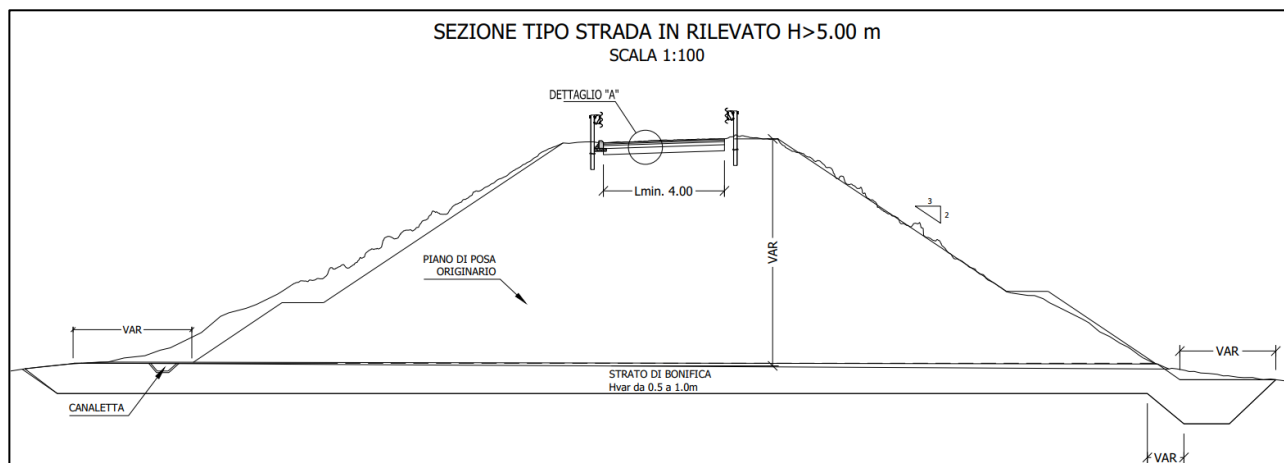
Sezione tipo strada in rilevato con  $H > 5$  m
